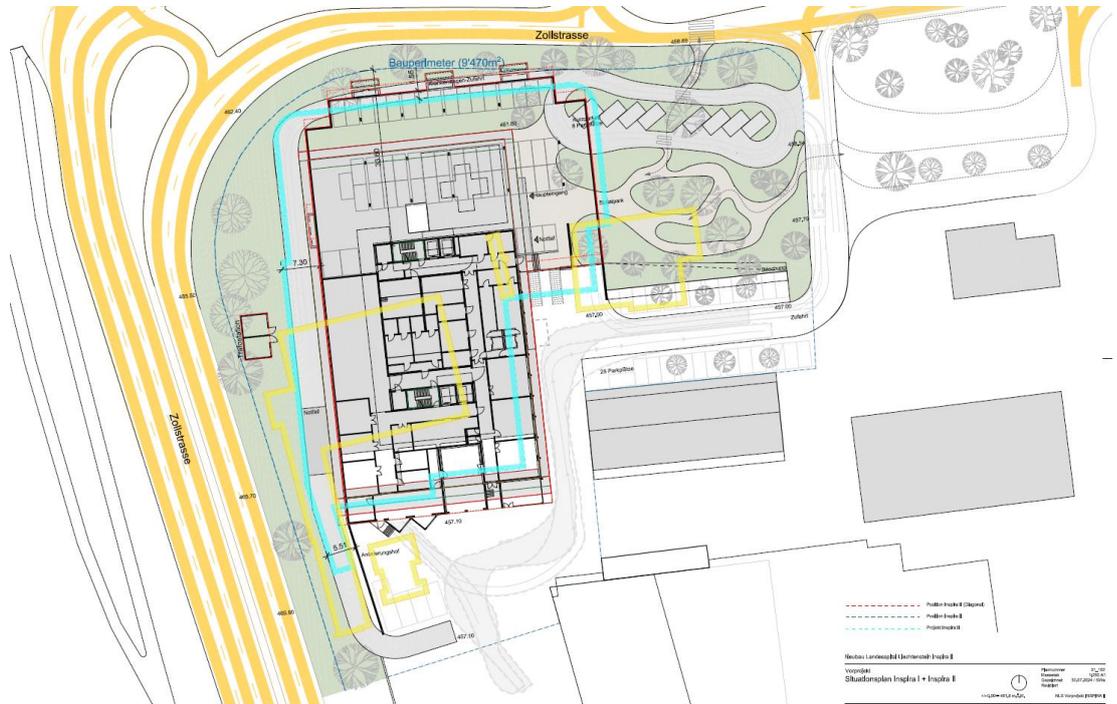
Situationsplan Vorprojekt NLS und Ausbau Zollstrasse, rot Lage Neubau Spital, gelb Abbruch best. Gebäude
